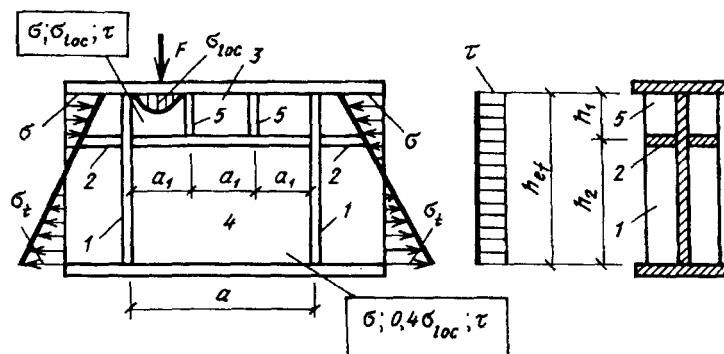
Схема балки, укрепленной основными поперечными ребрами жесткости (1), продольным ребром жесткости (2), разделяющим отсек стенки на пластину (3) у сжатого пояса и пластину (4) у растянутого пояса, а также к ороткими ребрами жесткости (5)
